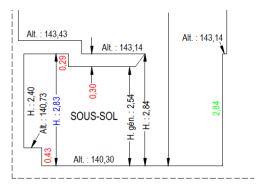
Coupe spécifique (extrait) — Planchers de type commun — Hauteurs facultatives
